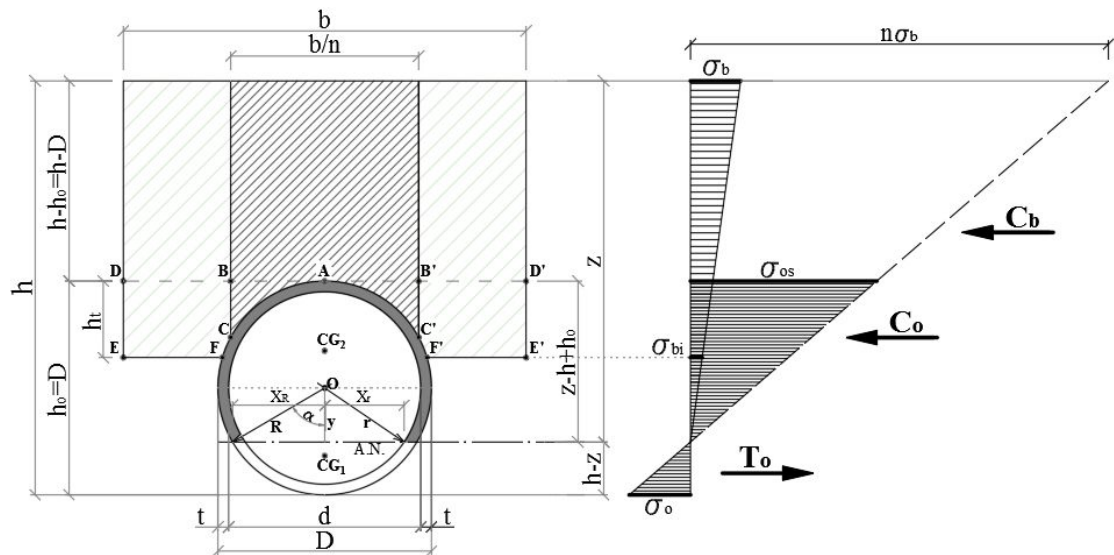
3. Model de calcul pentru structură mixtă oțel-beton cu structura metalică din țevi de oțel distanțate
